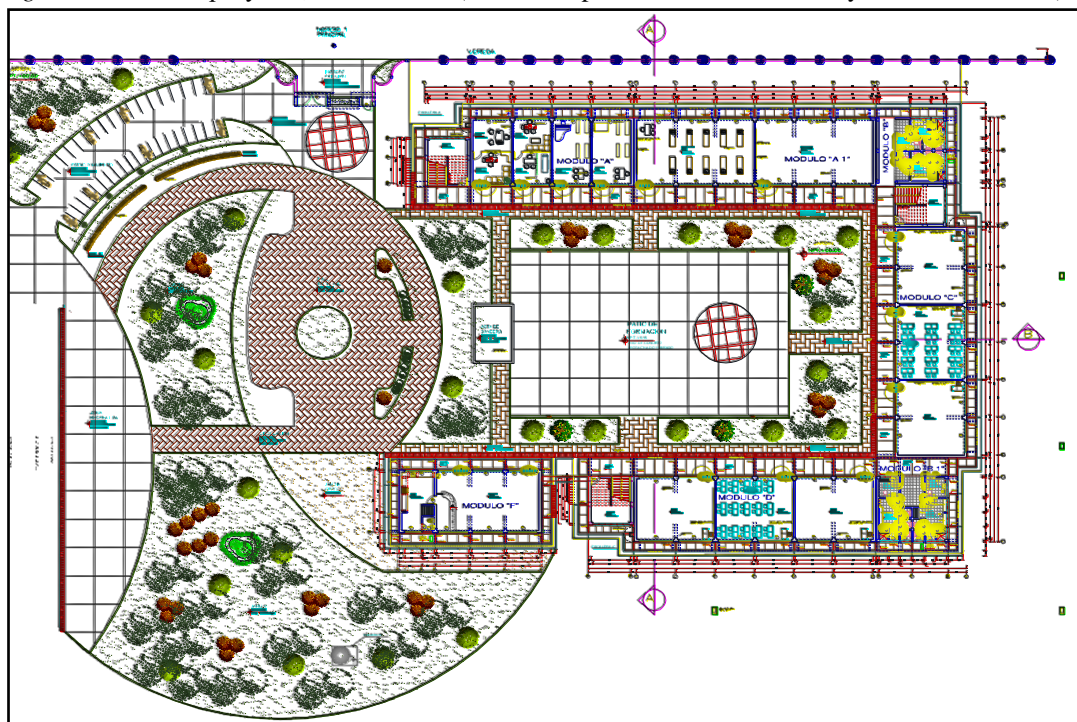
Vista general del Proyecto (Fuente: Expediente Técnico del Proyecto, Planos – Planta General - Arquitectura Primer Nivel – PG-01)
